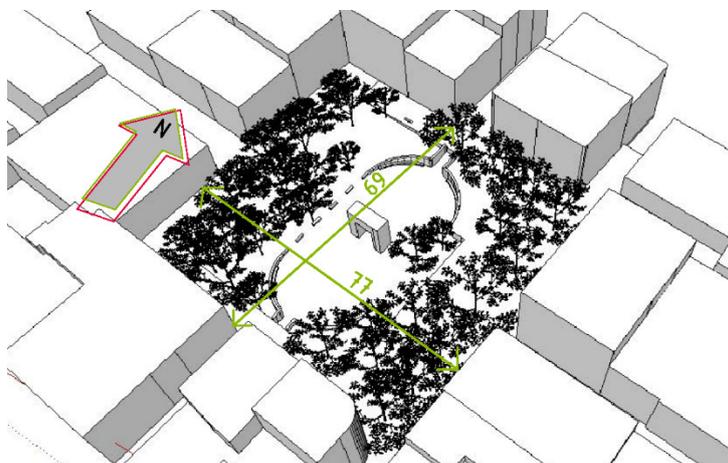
Levantamiento 3D de la Plaza del 2 de Mayo con orientación y dimensiones generales. Elaboración propia.
